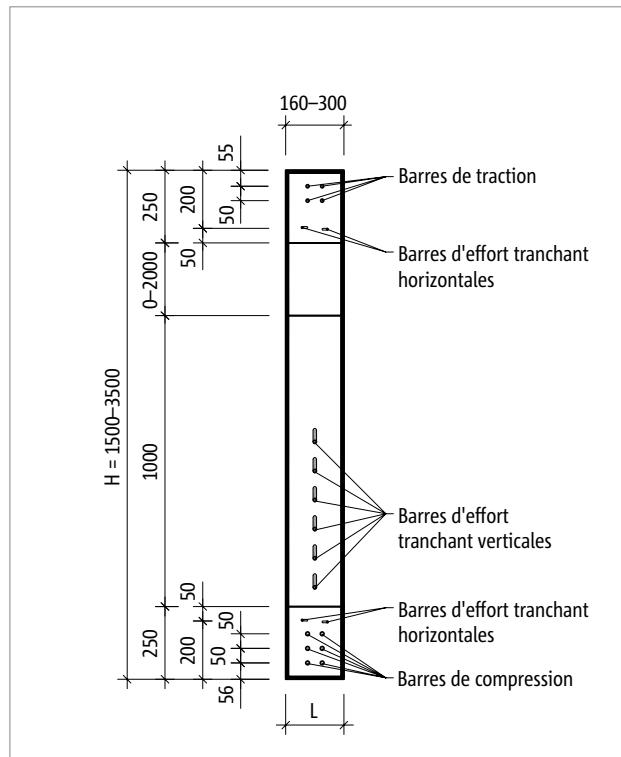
Schöck Isokorb® T type W-M4-R90 : vue du produit ; plaques coupe-feu sur tout le pourtour
